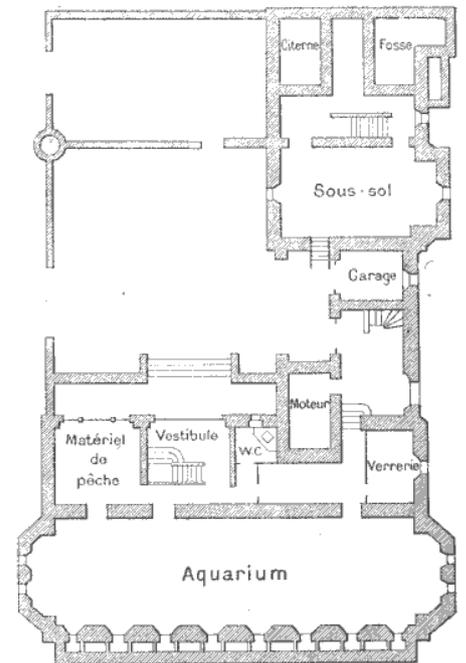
Plan de la station zoologique (rez-de-chaussée).
